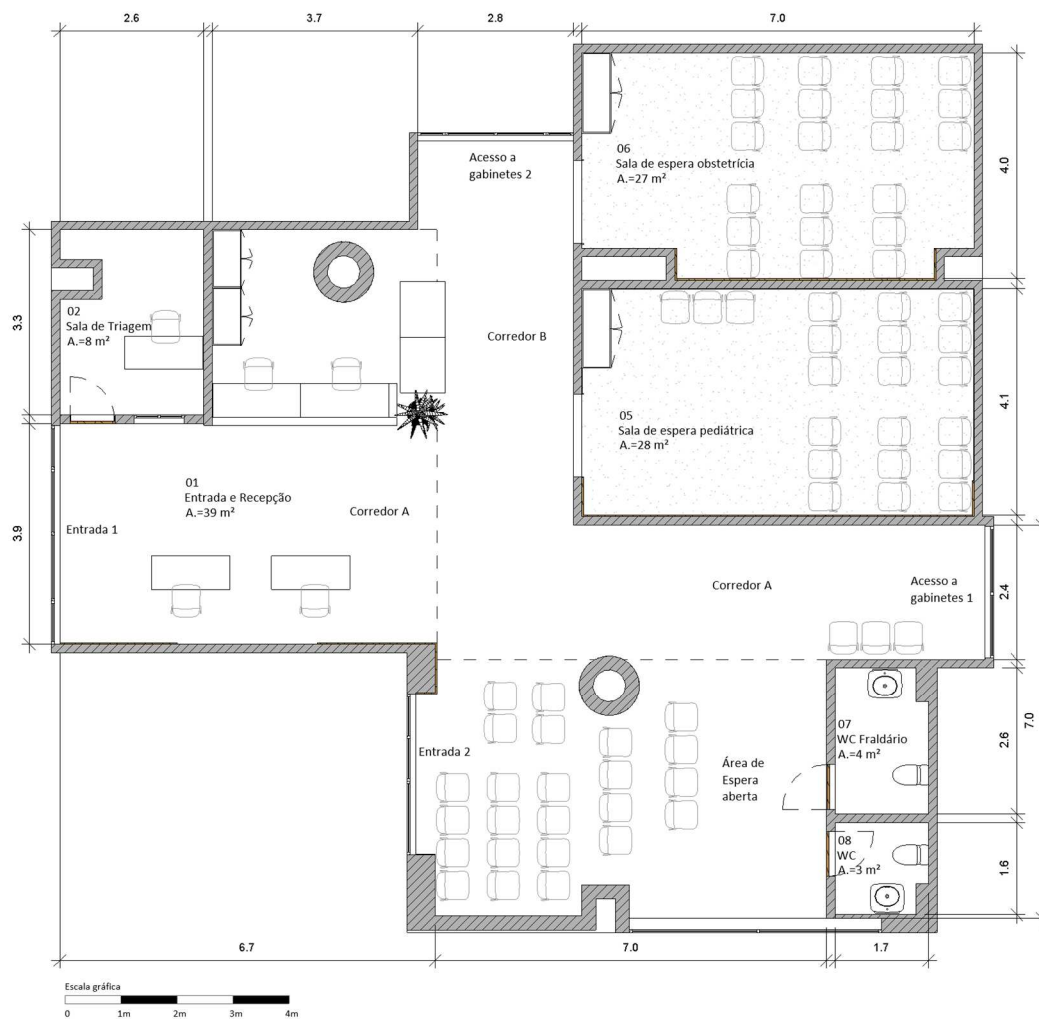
Planta de Arquitetura Existente. Fonte: Autora
